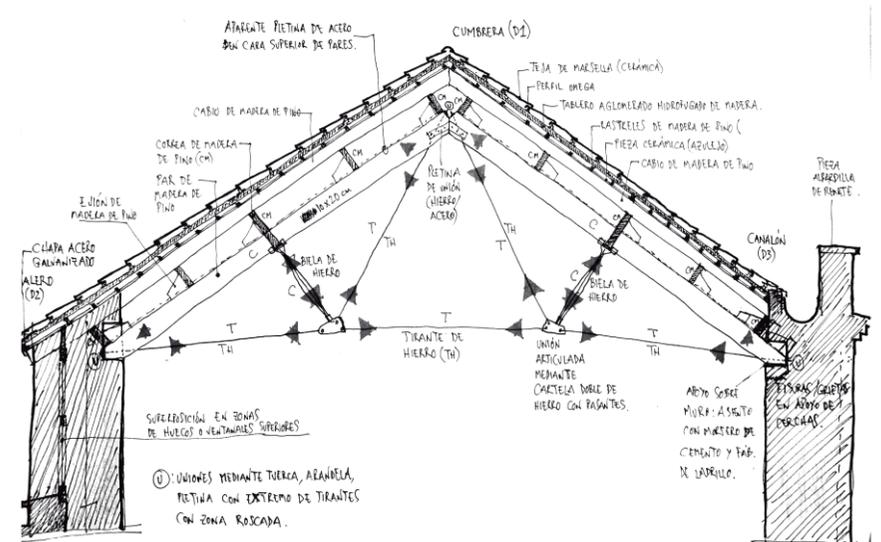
Croquis de detalle constructivo del edificio. Elaboración propia.
